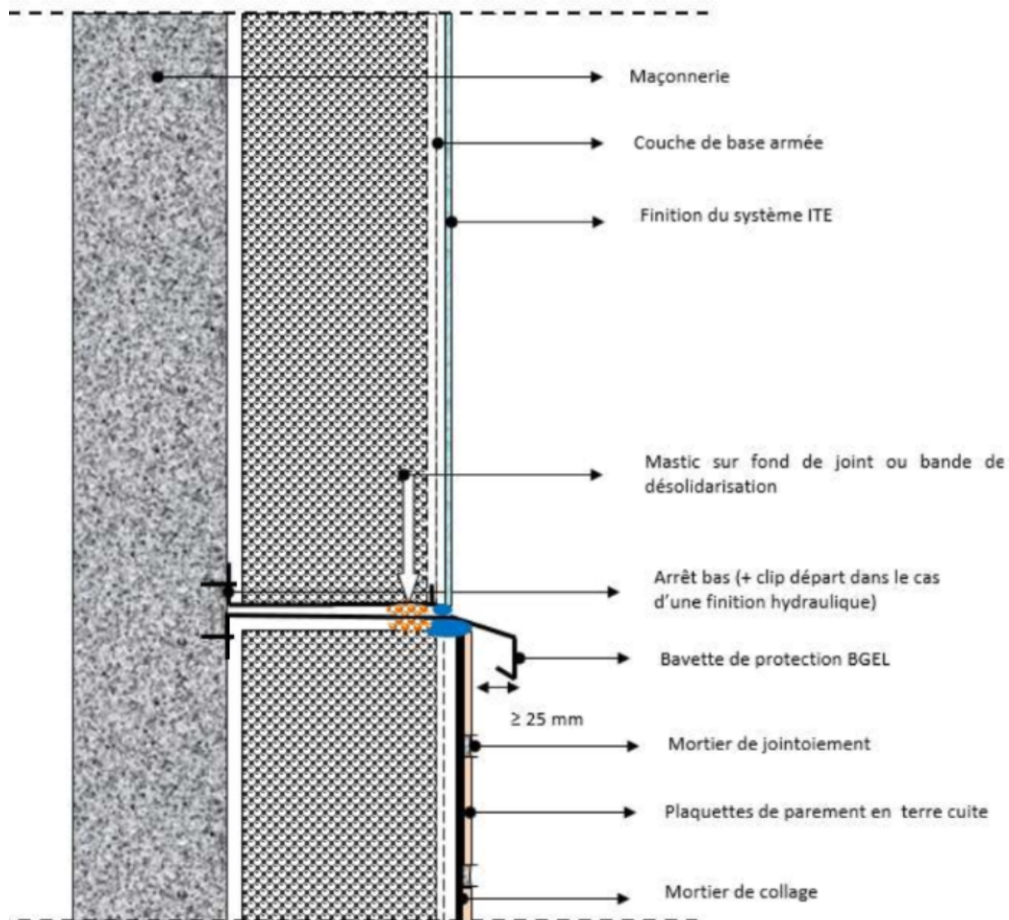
Finitions plaquettes de parement en terre cuite : raccordement avec un système d'enduit sur isolant avec utilisation d'une bavette (la fixation des panneaux isolants sur la maçonnerie n'est pas symbolisée)
